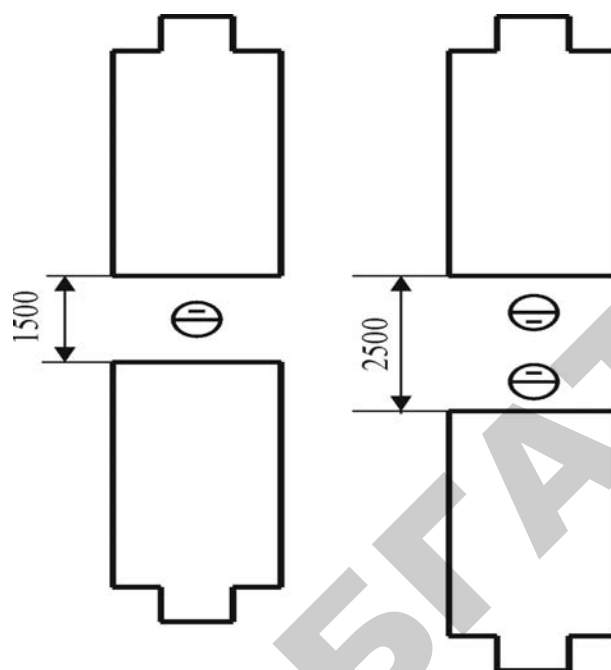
Расстояния между стендами и строительными конструкциями
